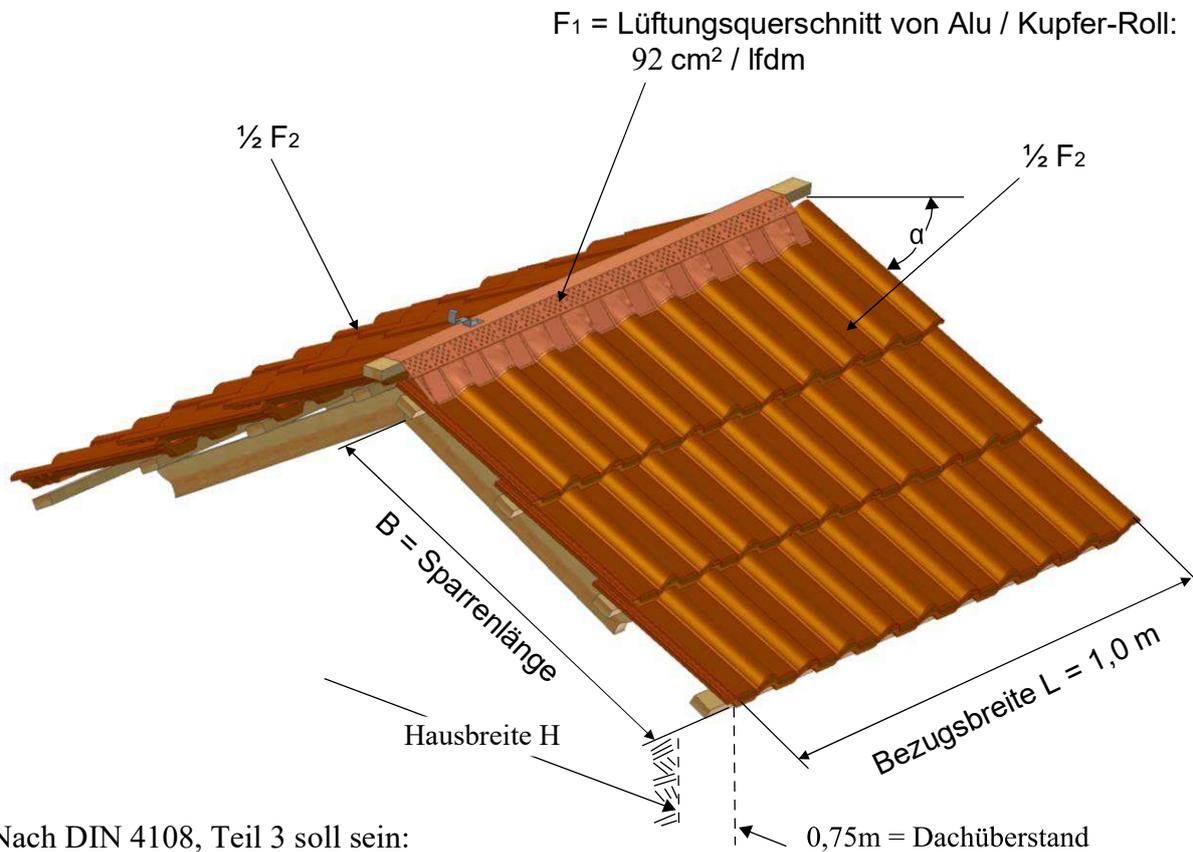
Konstruktionsbeispiel: belüftete Dachkonstruktion mit Dachdeckung, Zwischensparrendämmung, ggf. in Kombination mit geringfügiger Untersparrendämmung
